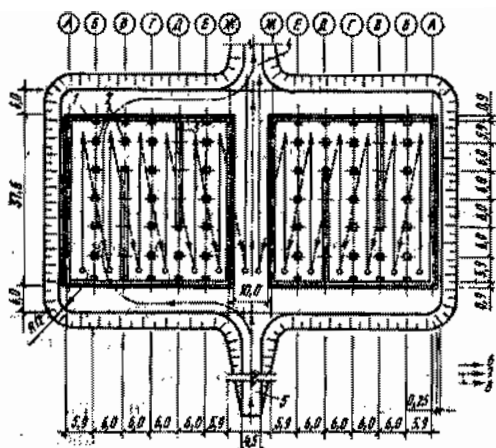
Схемы движения монтажных кранов при возведении двух крупных резервуаров: 1 - стеновые панели; 2 - колонны в котловане; 3 - циркуляционные перегородки; 4, 5 - выезд из котлована и выезд в него; 6 - рабочий ход крана (→); 7 - обратный ход (←); 8 - направление движения транспортных средств (— →)
